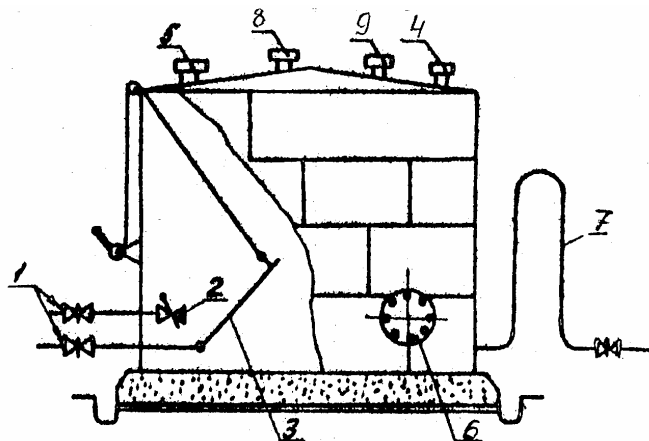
Схема расположения оборудования на стальном резервуаре
